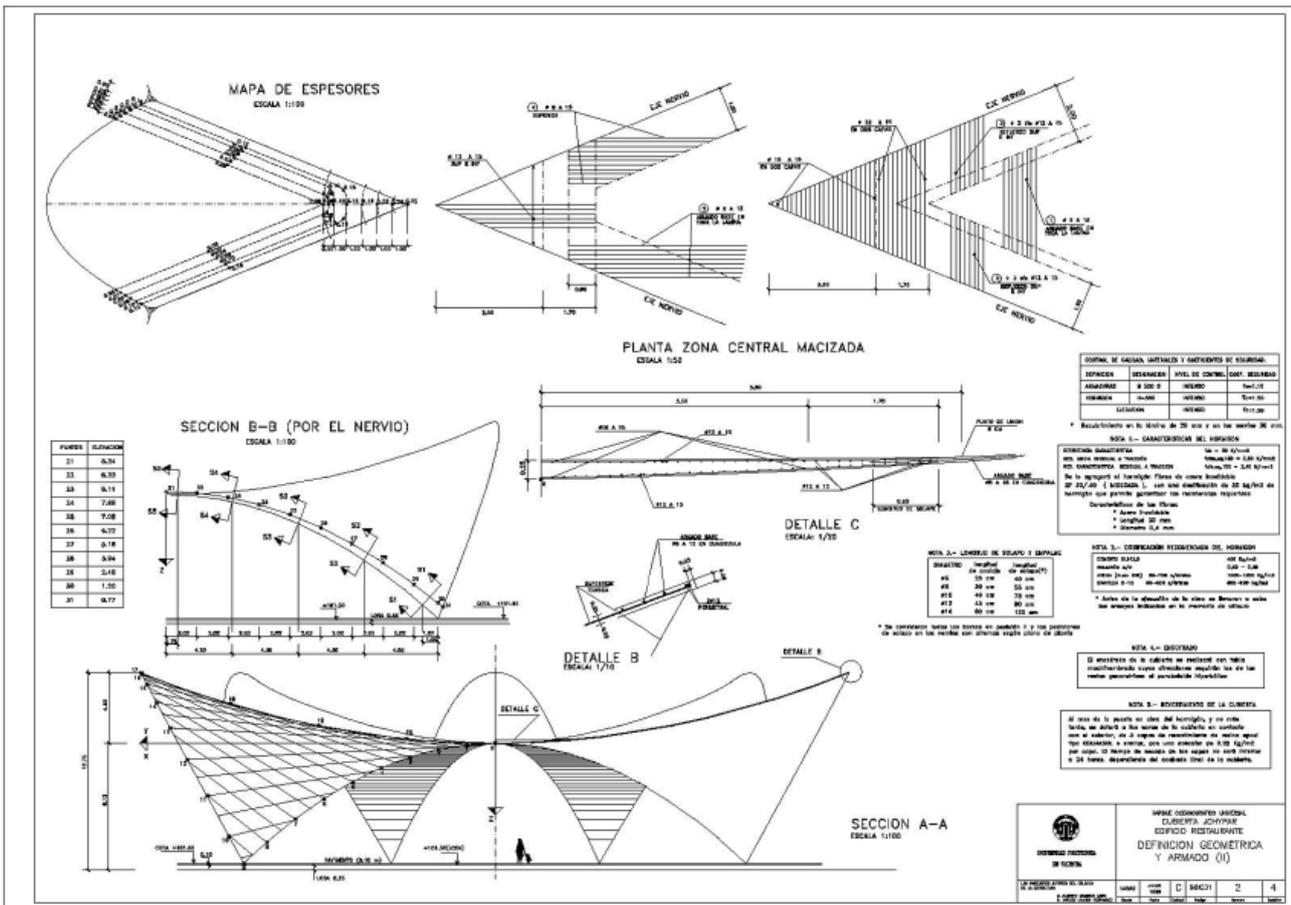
Plano del proyecto de ejecución de la cubierta del restaurante
